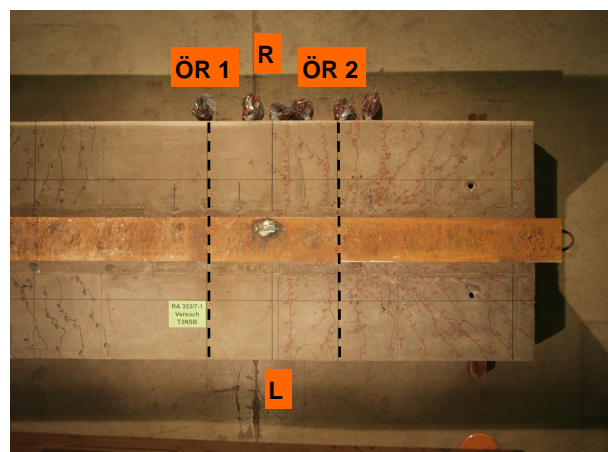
Rissbild auf der Betongurtunterseite
